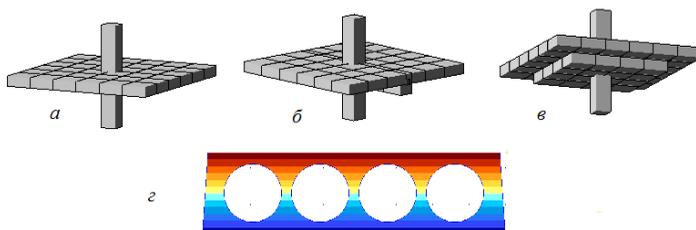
Виды монолитного перекрытия (а – плоское, б – балочное, в – с капителями), г - поперечное сечение изогнутой многопустотной плиты перекрытия
